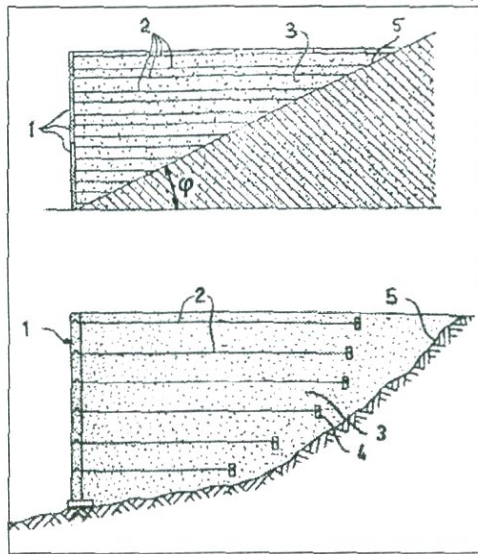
Типовой разрез удерживающей и дренажной конструкции на склоне: 1 – подпорная стена с железобетонными ригелями; 2 – послойная сетчатая грунто-полимерная конструкция; 3 – слой засыпки; 4 – железобетонные ригели; 5 – естественный склон
